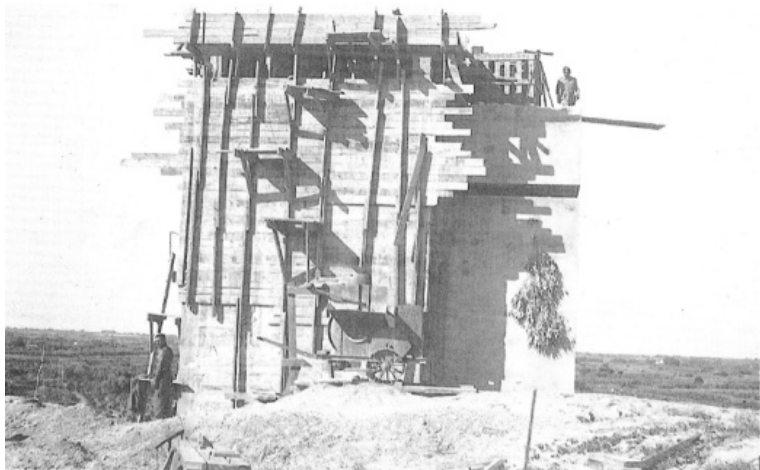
Construcción del P.C. de la Batería de Punta Candor. 23 de mayo de 1943.
